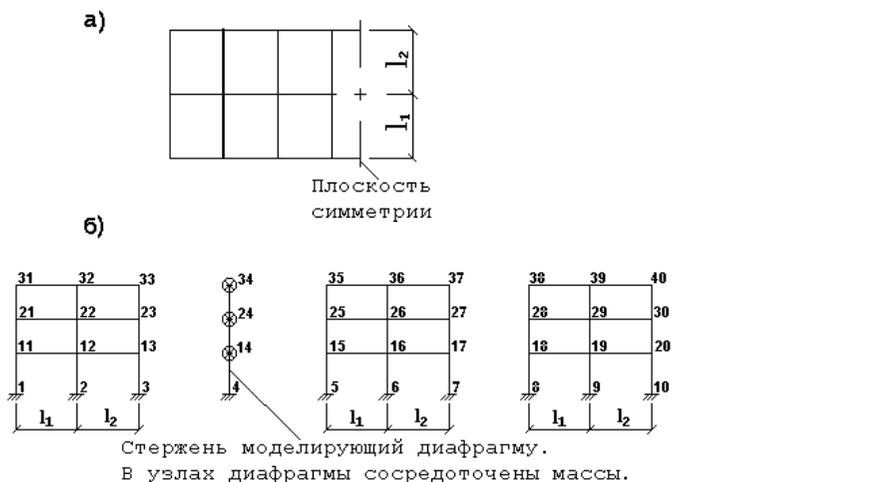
Замена пространственного каркаса здания плоской расчетной схемой
